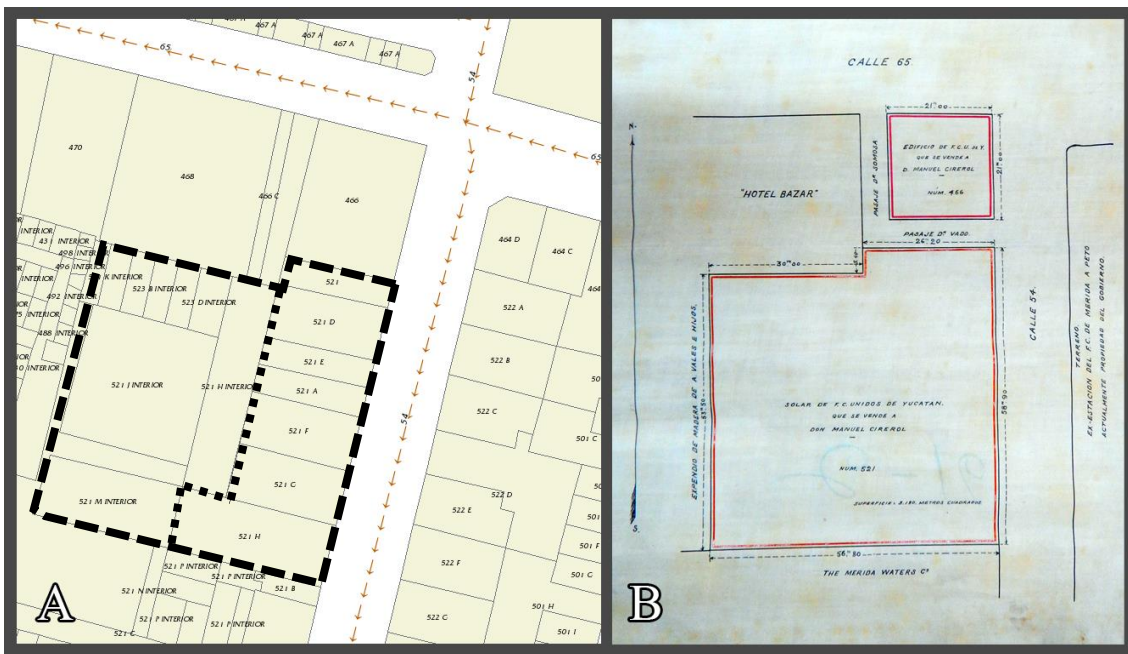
A= División actual en el plano SIG y B= Estado Original del Lote 521, sección del plano original (anexo 11).
